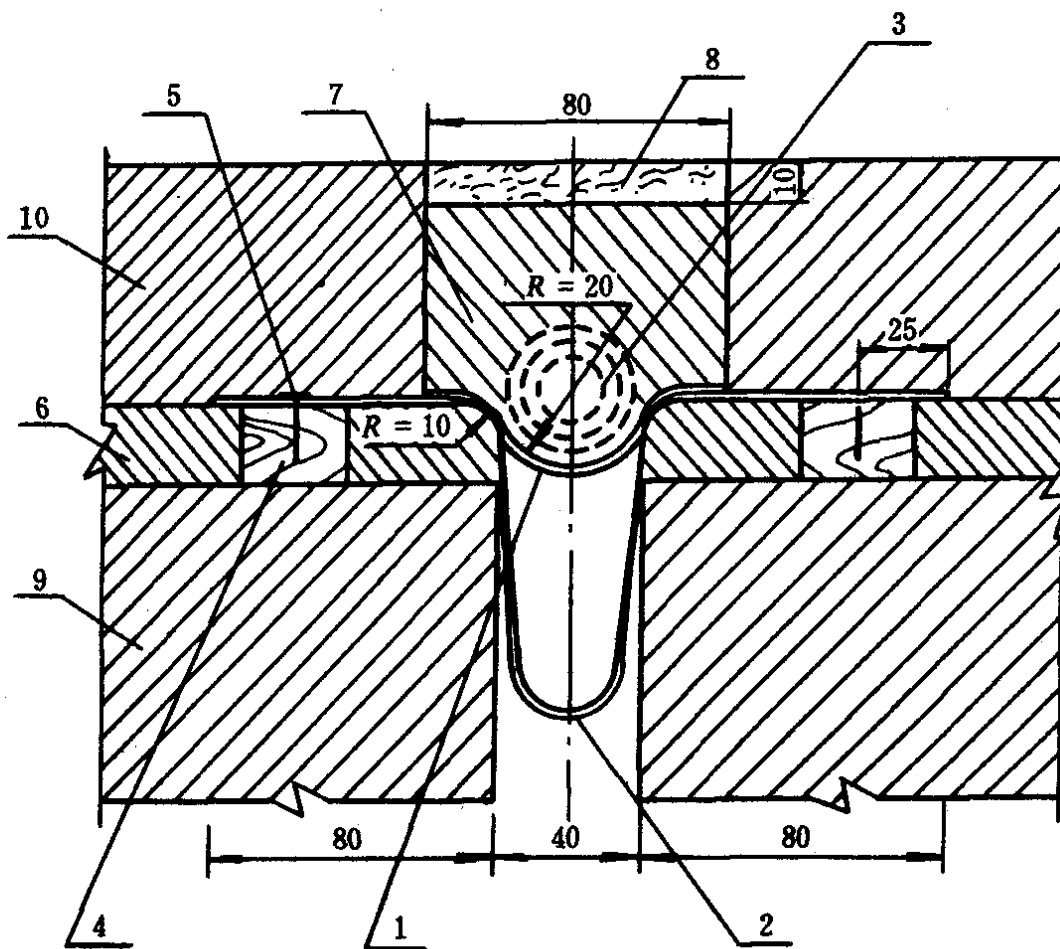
U型镀锌铁皮伸缩装置构造示意图
